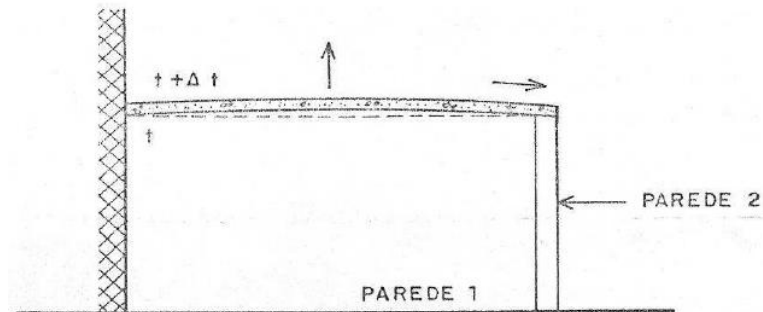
Caso de fissuração vertical junto à fundação e à laje de cobertura em paredes de concreto em edifícios
